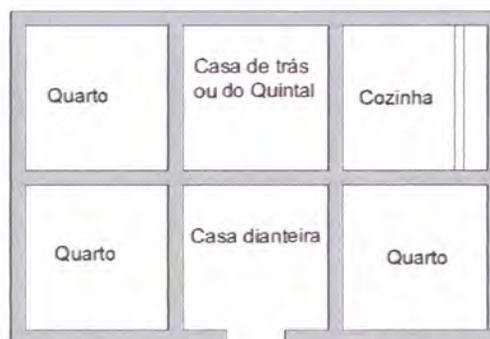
Planta esquemática da 2ª fase do Tipo 3 na rua da Boavista, nº58
